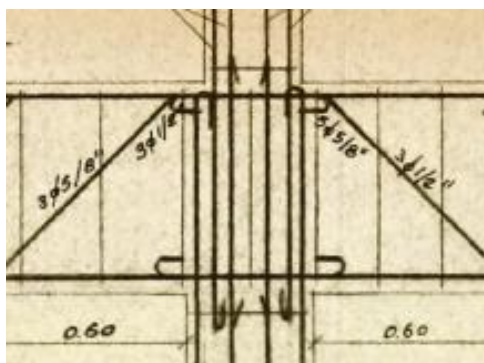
Emenda e ancoragem da armadura longitudinal de um pilar do edifício em estudo num nó de ligação viga-pilar.
